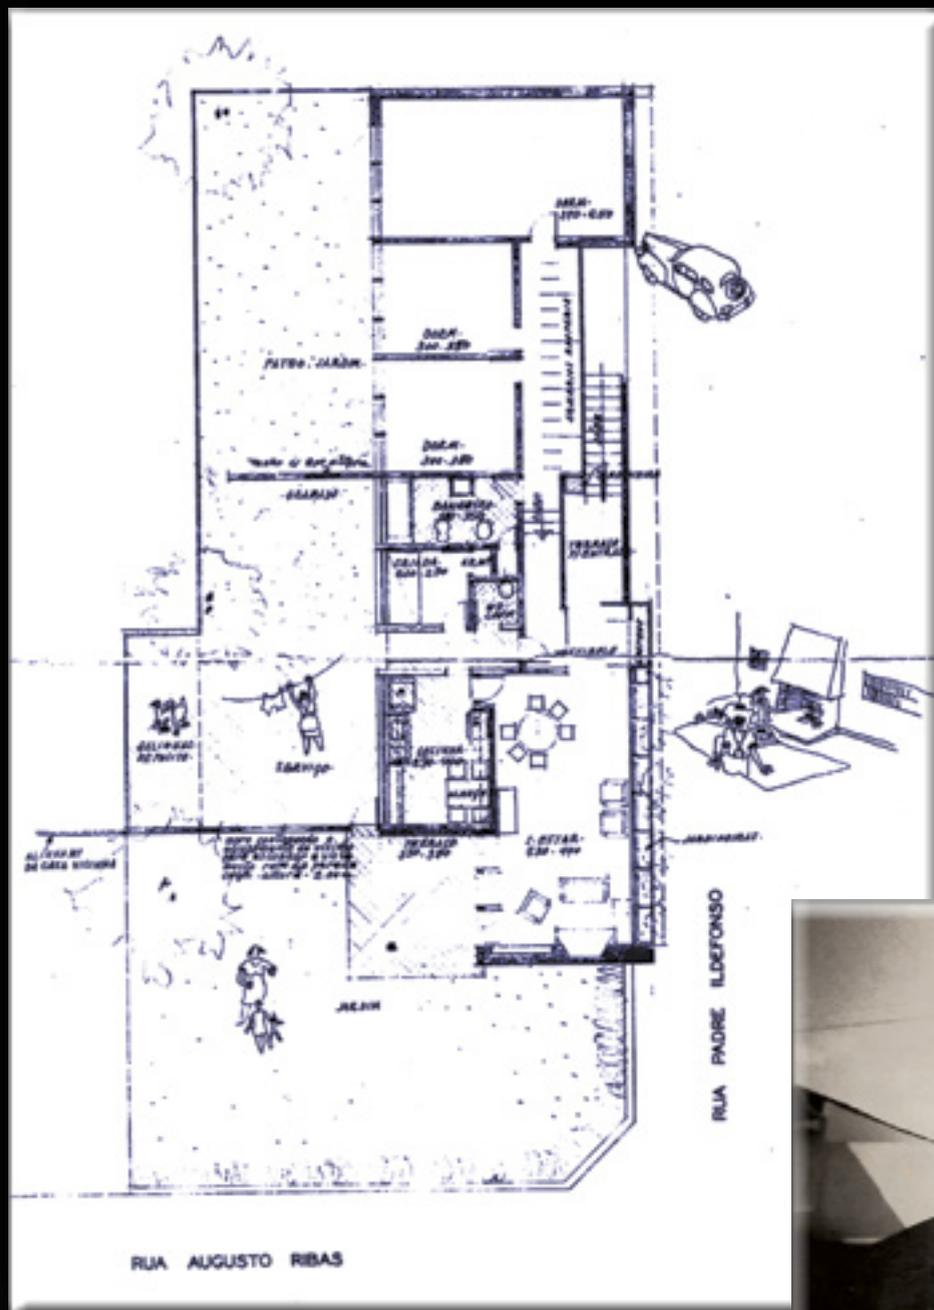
Planta do estudo da Res. Orlando Holzmann.
